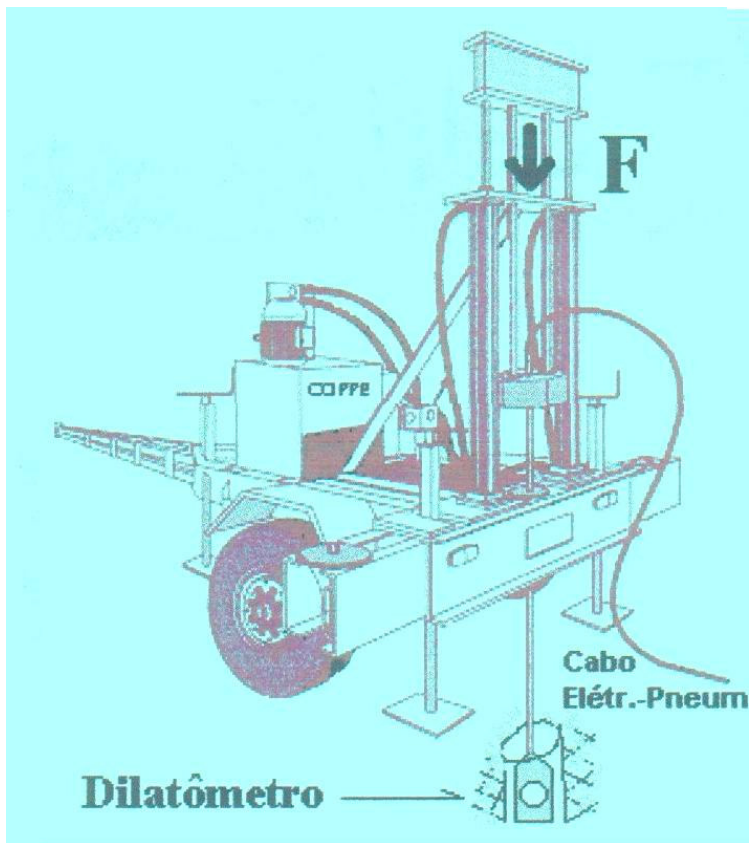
Layout do sistema empregado para a cravação do dilatômetro.
